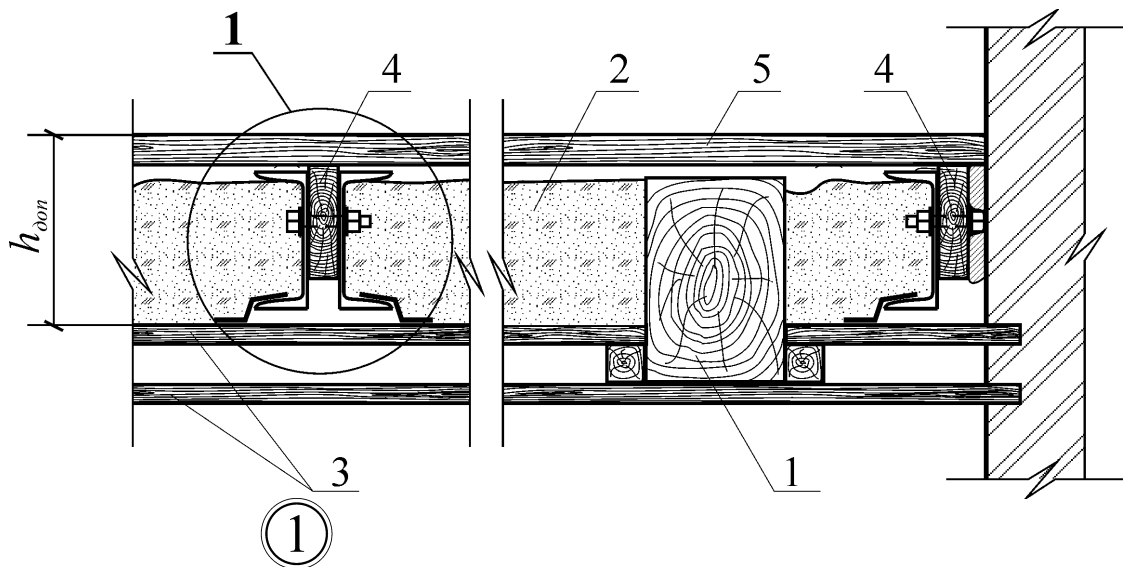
Реконструкция перекрытия с использованием разгружающих балок: 1 — деревянные балки перекрытия, 2 — межбалочная засыпка, 3 — доски подшивки перекрытия, 4 — разгружающие балки, 5 — поперечный накат пола, 6 — защитные экраны из оцинкованной стали
